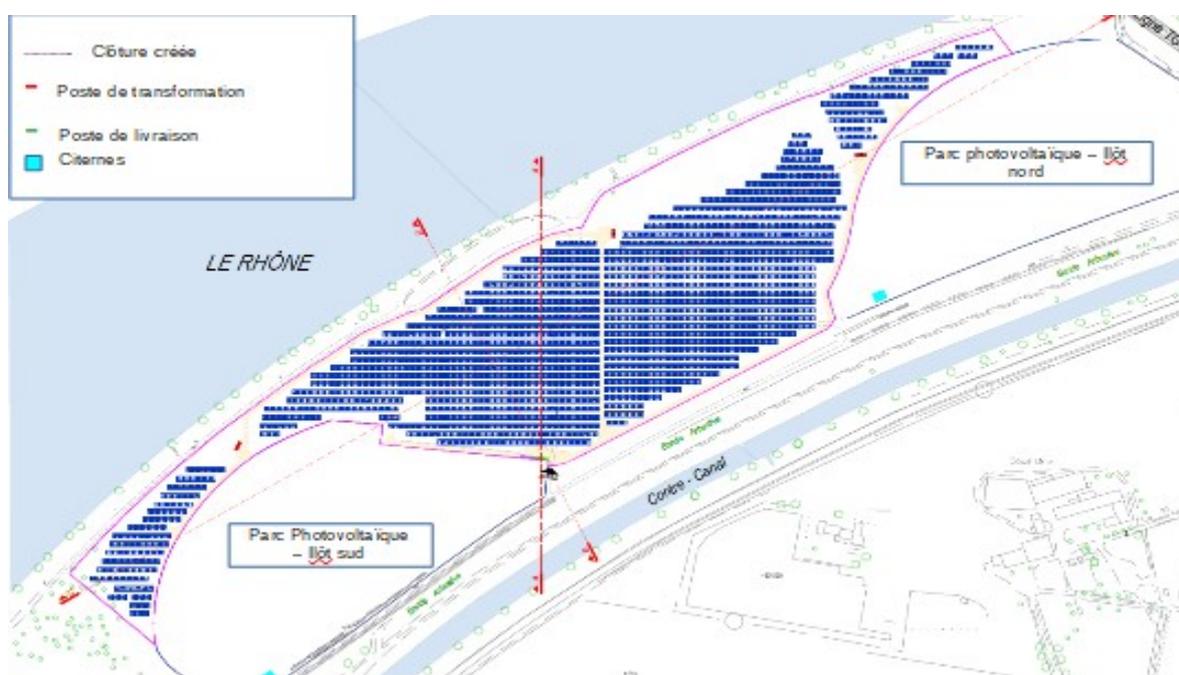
Plan de masse du projet. Source: dossier de permis de construire.
